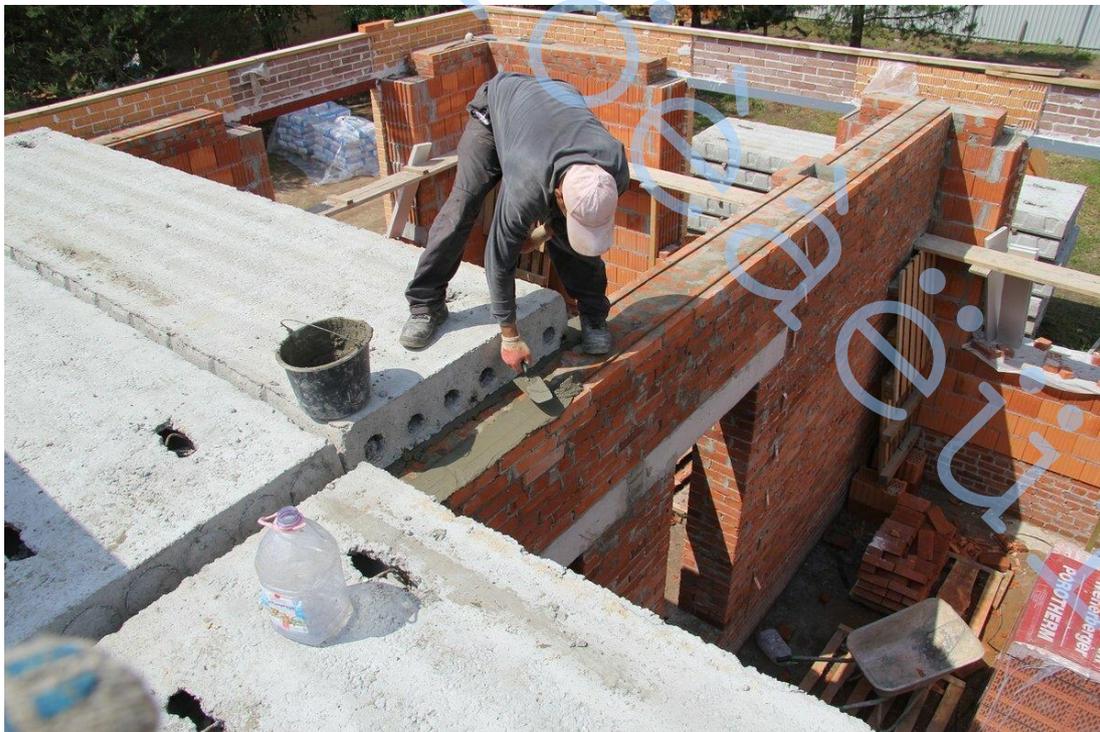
Монтаж многопустотных железобетонных плит ПК междуэтажного перекрытия
